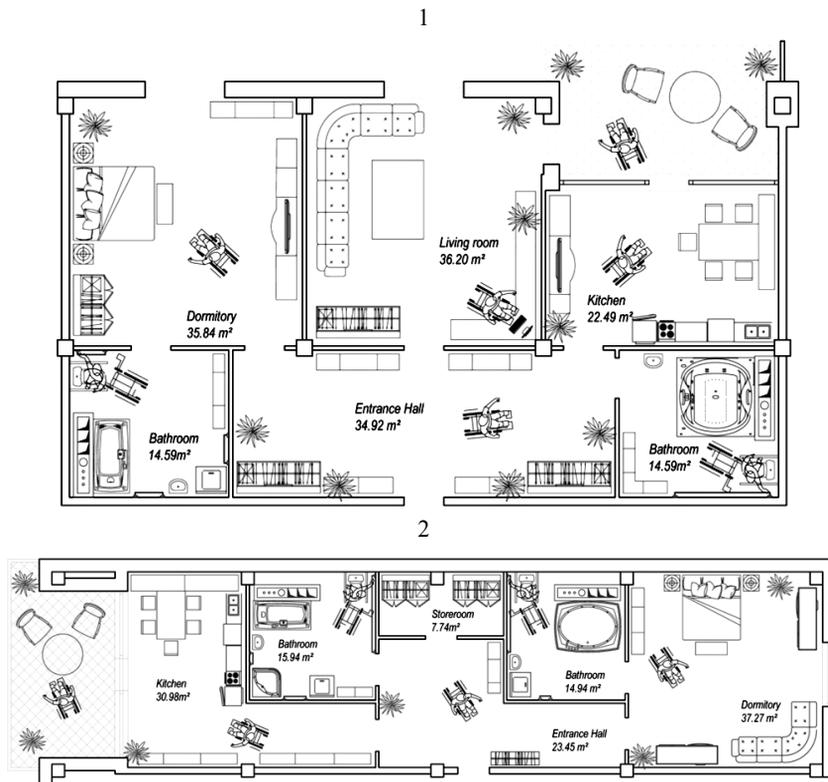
Эскизный проект многоэтажного жилого дома с секционной планировкой (арх. А.Ф. Мондонико, А.Д. Муталиев, К.И. Самойлов, 2019): 1 – План двухкомнатной квартиры, 2 – План однокомнатной квартиры
